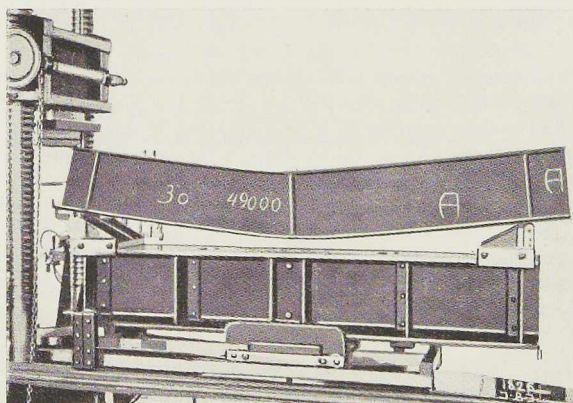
Essai d'une poutrelle munie de 3 raidisseurs.
